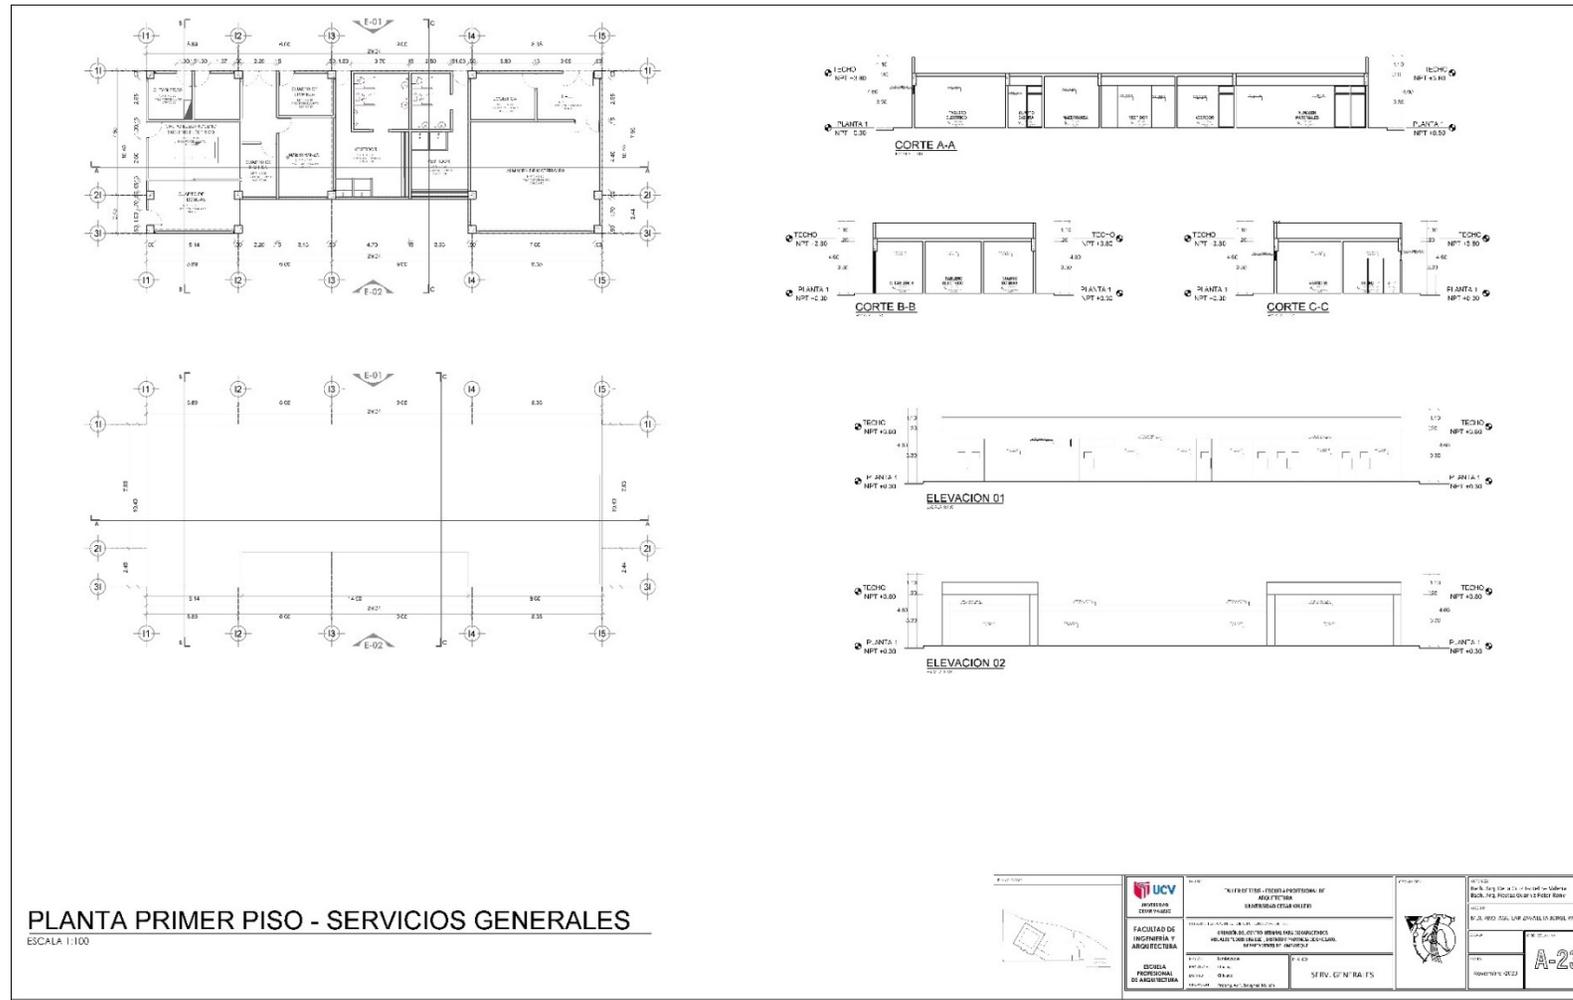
Planta,cortes, elevaciones- zona servicios generales. Fuente: elaboración propia.
